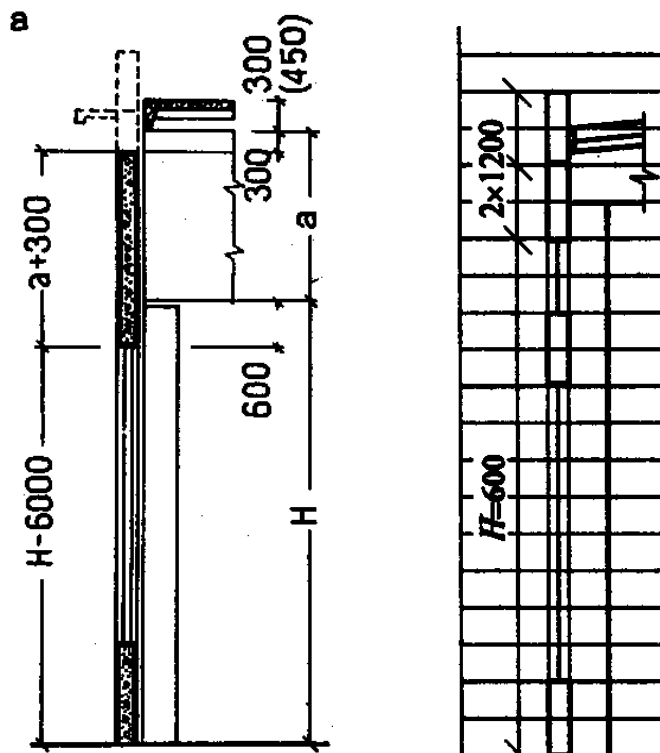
Схема раскладки панелей по условиям унификации в продольных стенах одноэтажных зданий;
